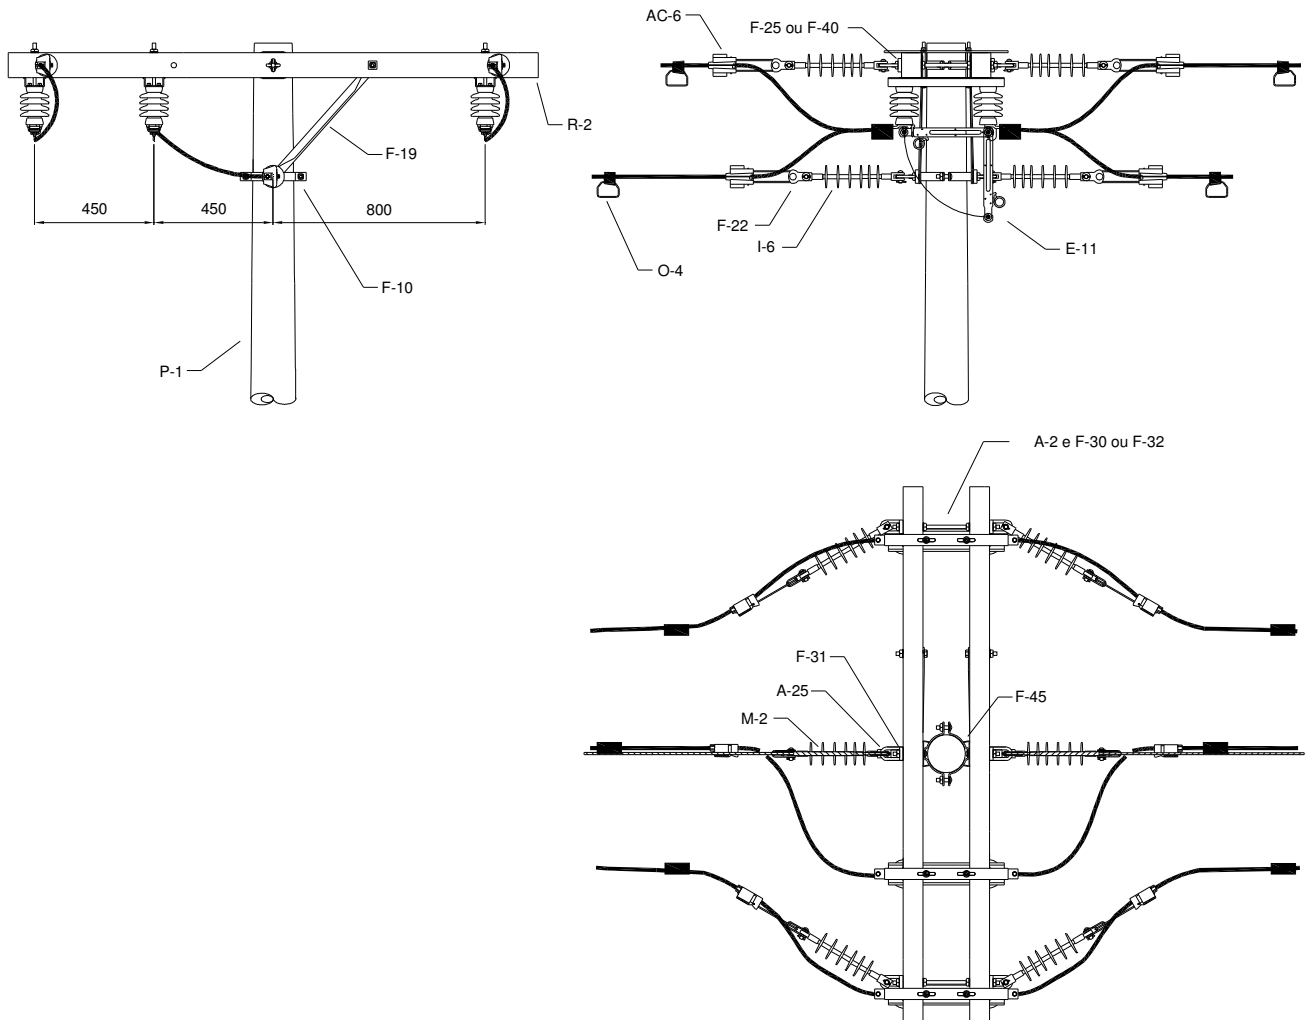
Estrutura CE4 SU – Poste de Concreto de seção circular
